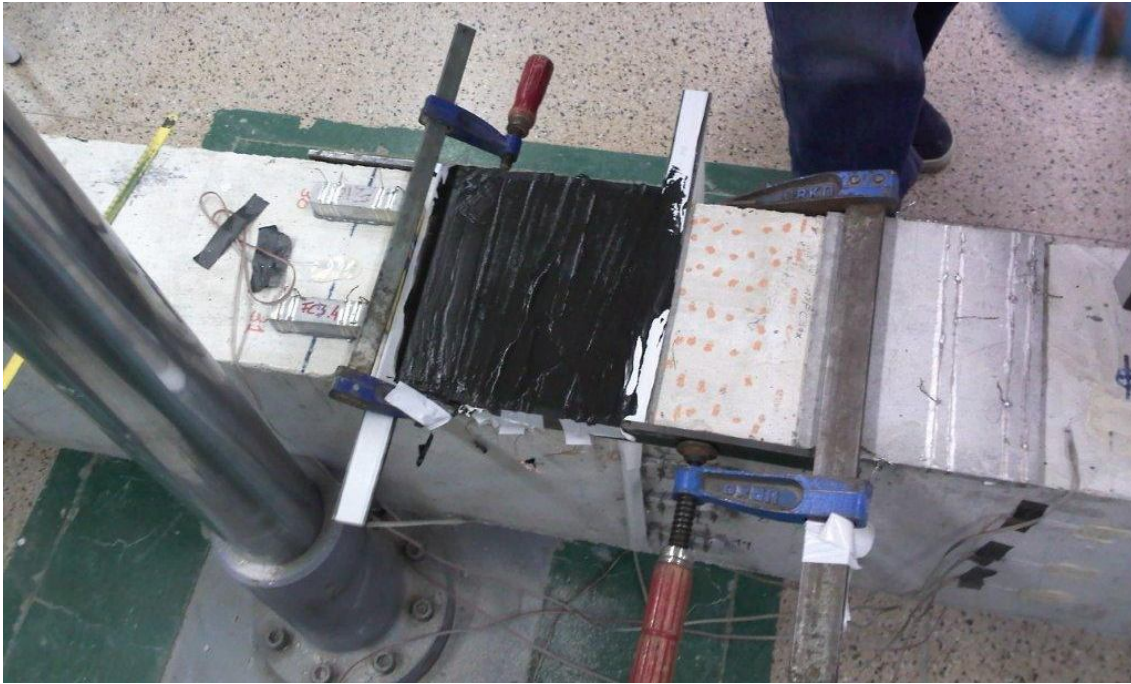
Sensor tipo placa extendida, de pasta de cemento con adición de un 2% de NFC, sobre viga de hormigón armado.
